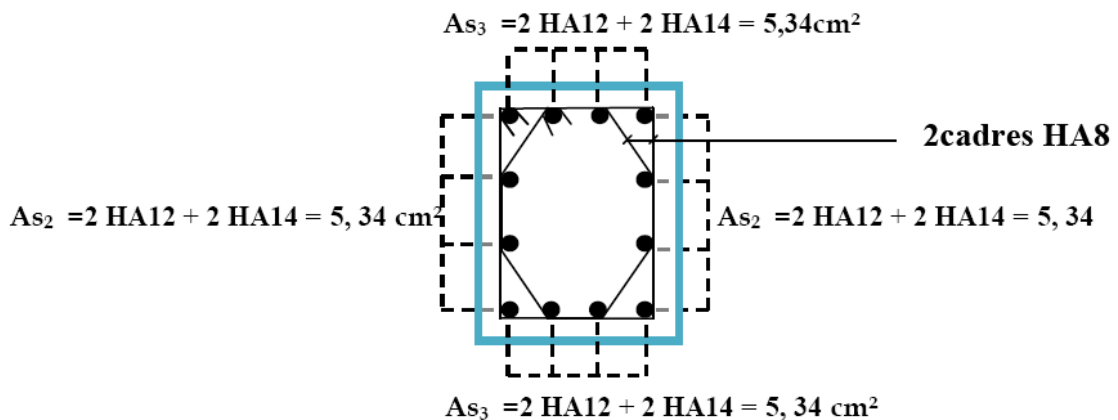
VII-1-2: Schéma ferrailage poteaux (50x50) zone I
